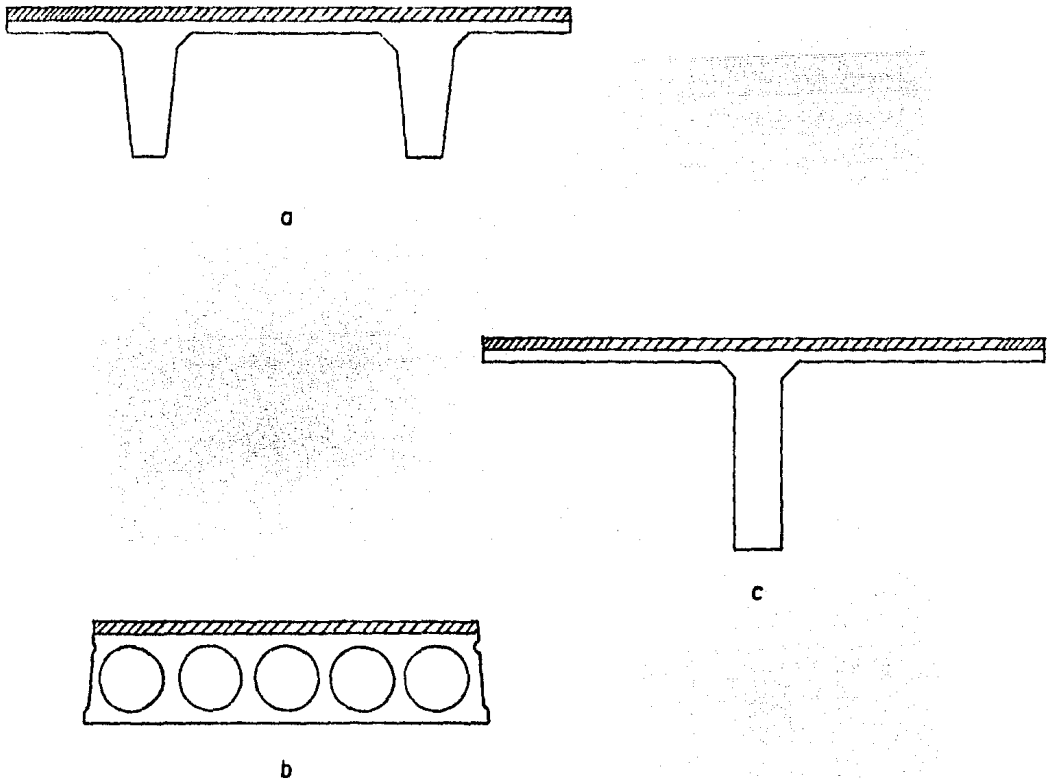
Secciones de vigas compuestas: a) Losa Doble TT; -- b) Losa Extruída c) Viga T sencilla.
